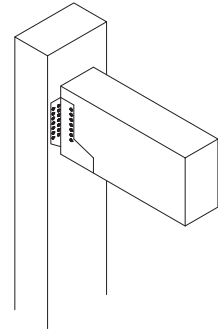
Axonometría constructiva de ejemplo de unión entre viga- pilar de madera.
